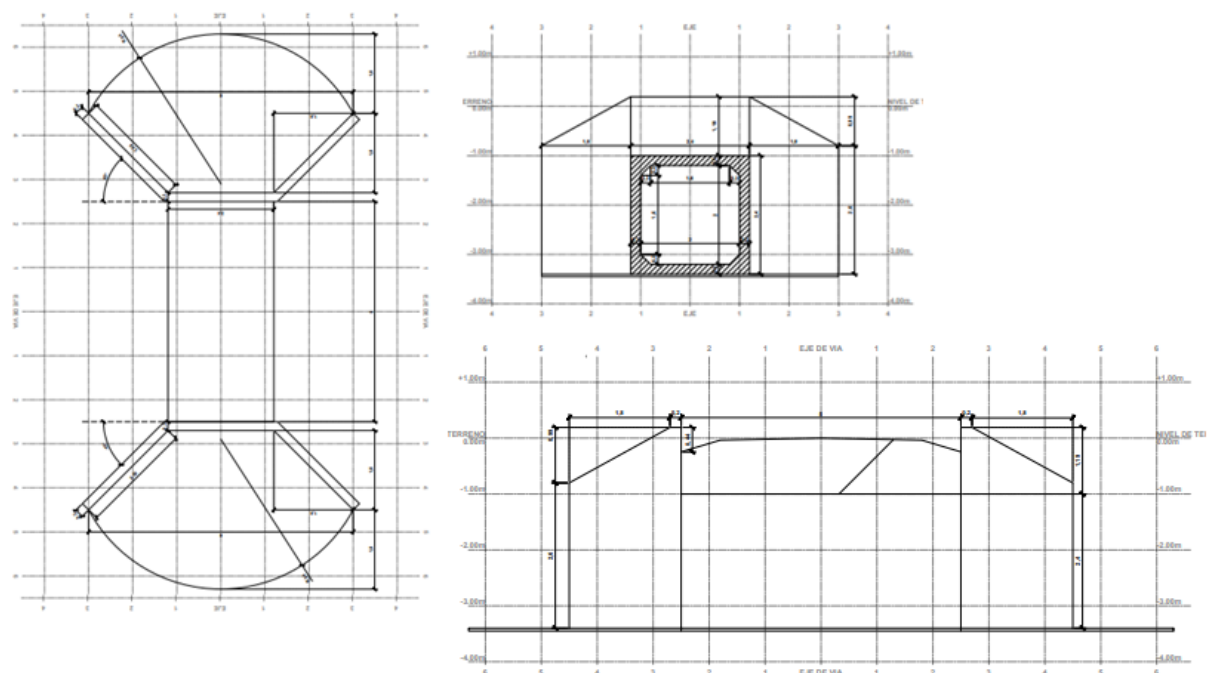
Vistas de planta, lateral y frontal del box culvert fuente(propia).
